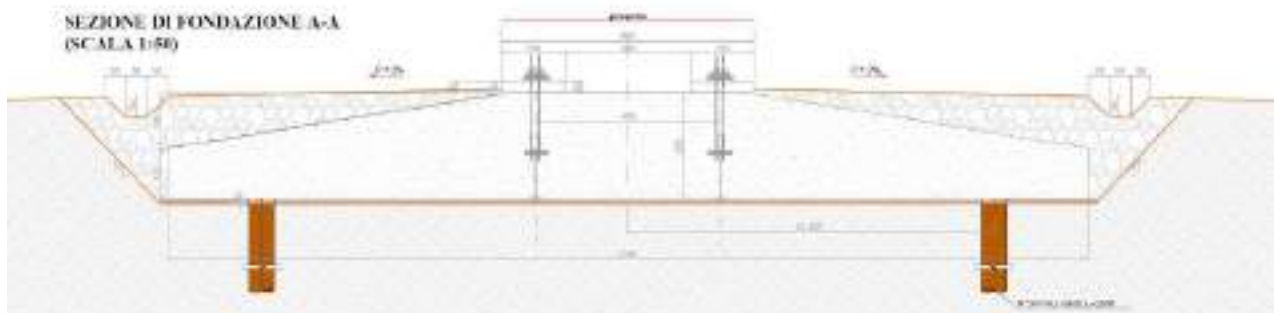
Geometria della fondazione su pali dell'aerogeneratore
